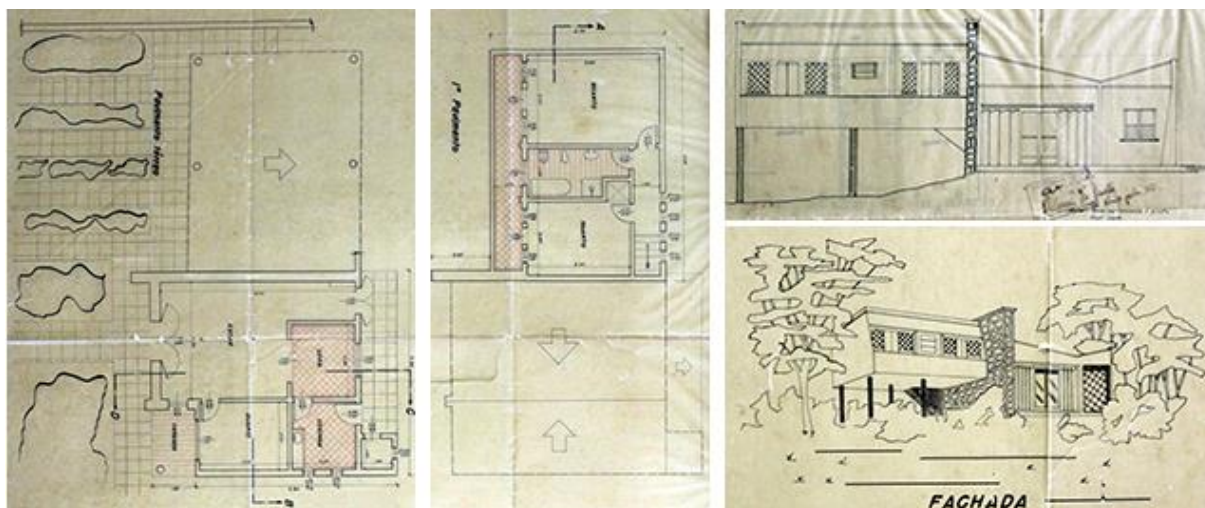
Projeto Casa de Campo Sr. Claudionor Reale, 1955. Da esquerda para direita, planta baixado Pavimento Térreo, planta baixa do 1º Pavimento e Fachada (superior) e Perspectiva (inferior). Fonte: Arquivo Público de Aracaju, editado pelos autores.
